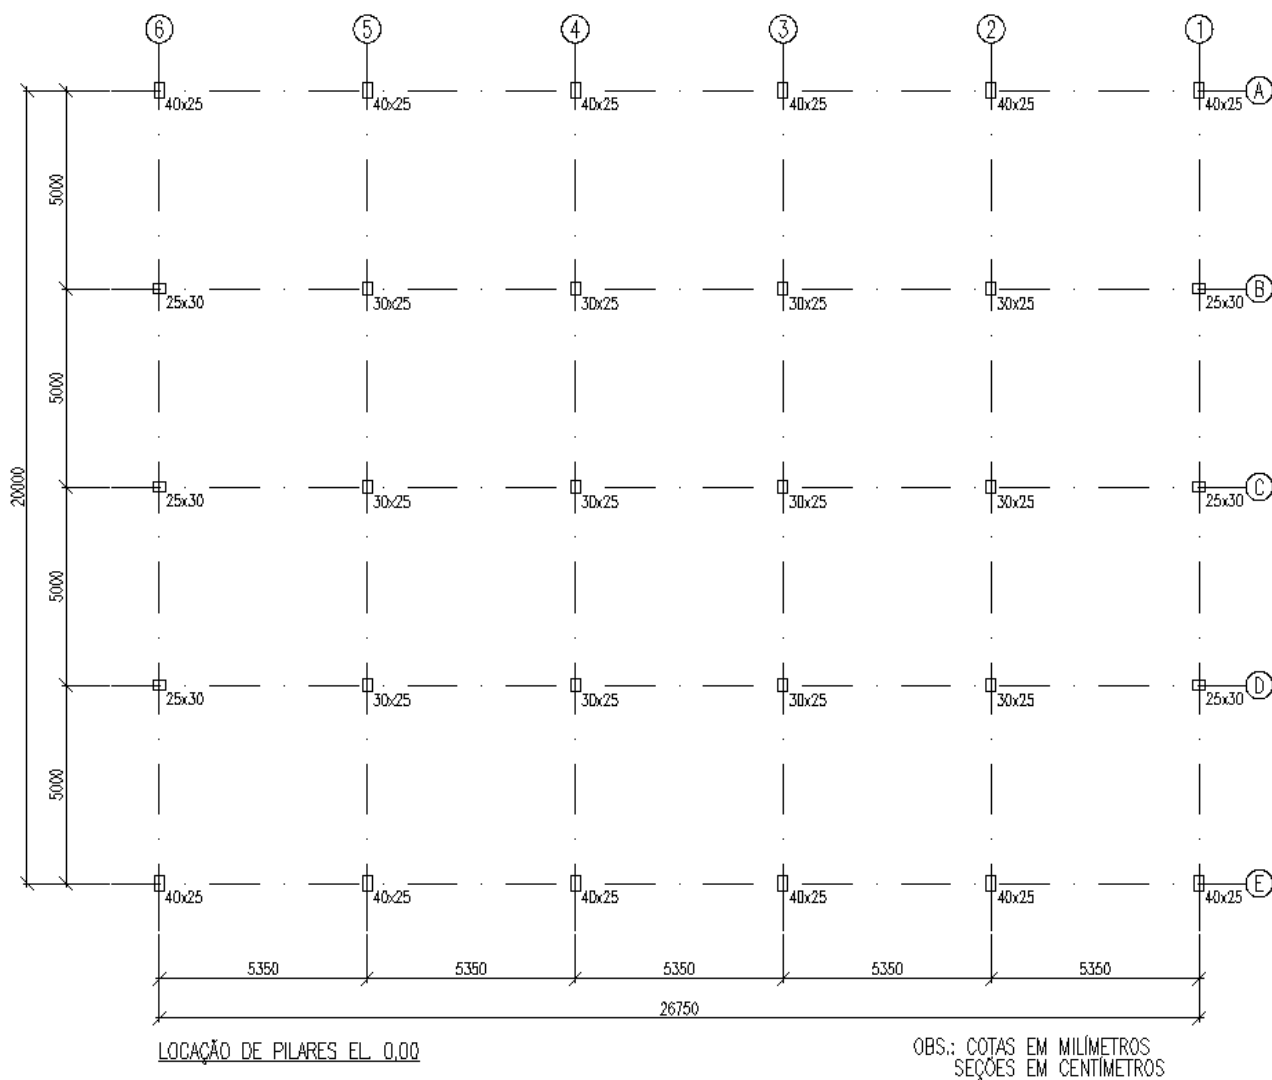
Planta baixa de localização dos pilares em concreto pré-moldado.
